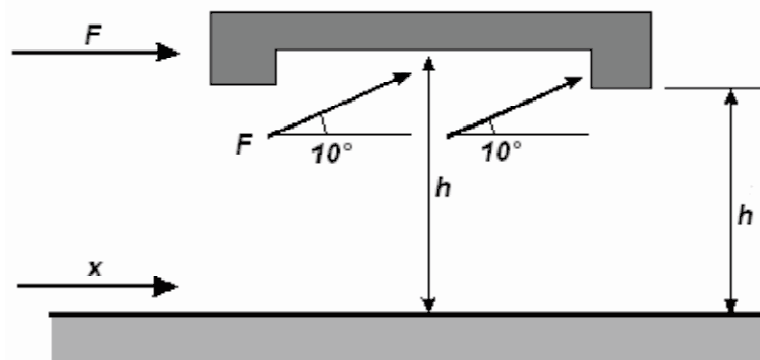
Сила від зіткнення з опорними конструкціями будівель
